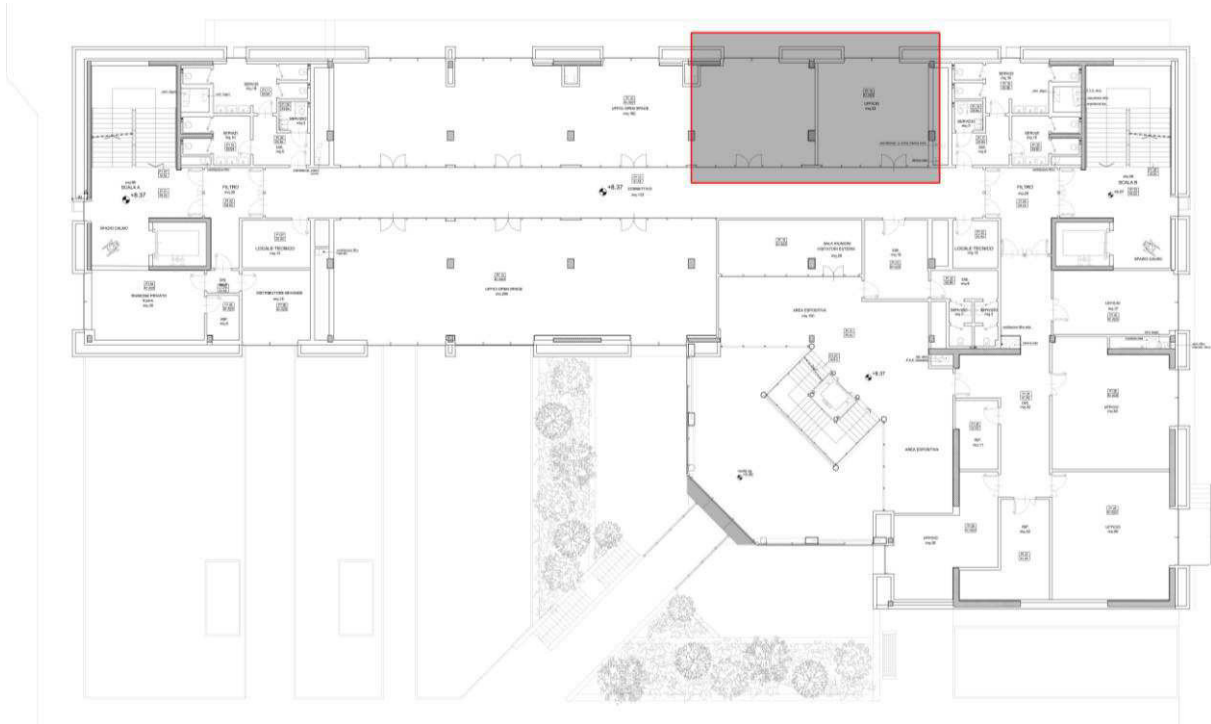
Pianta primo piano con individuazione degli ambienti analizzati
